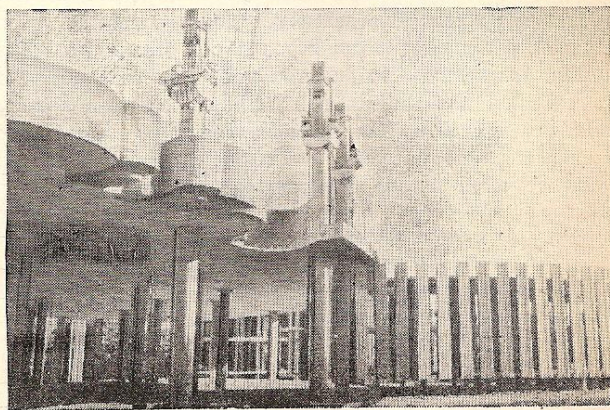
Подъем изготовленной на земле плиты крыши с карнизом для корпуса Б
